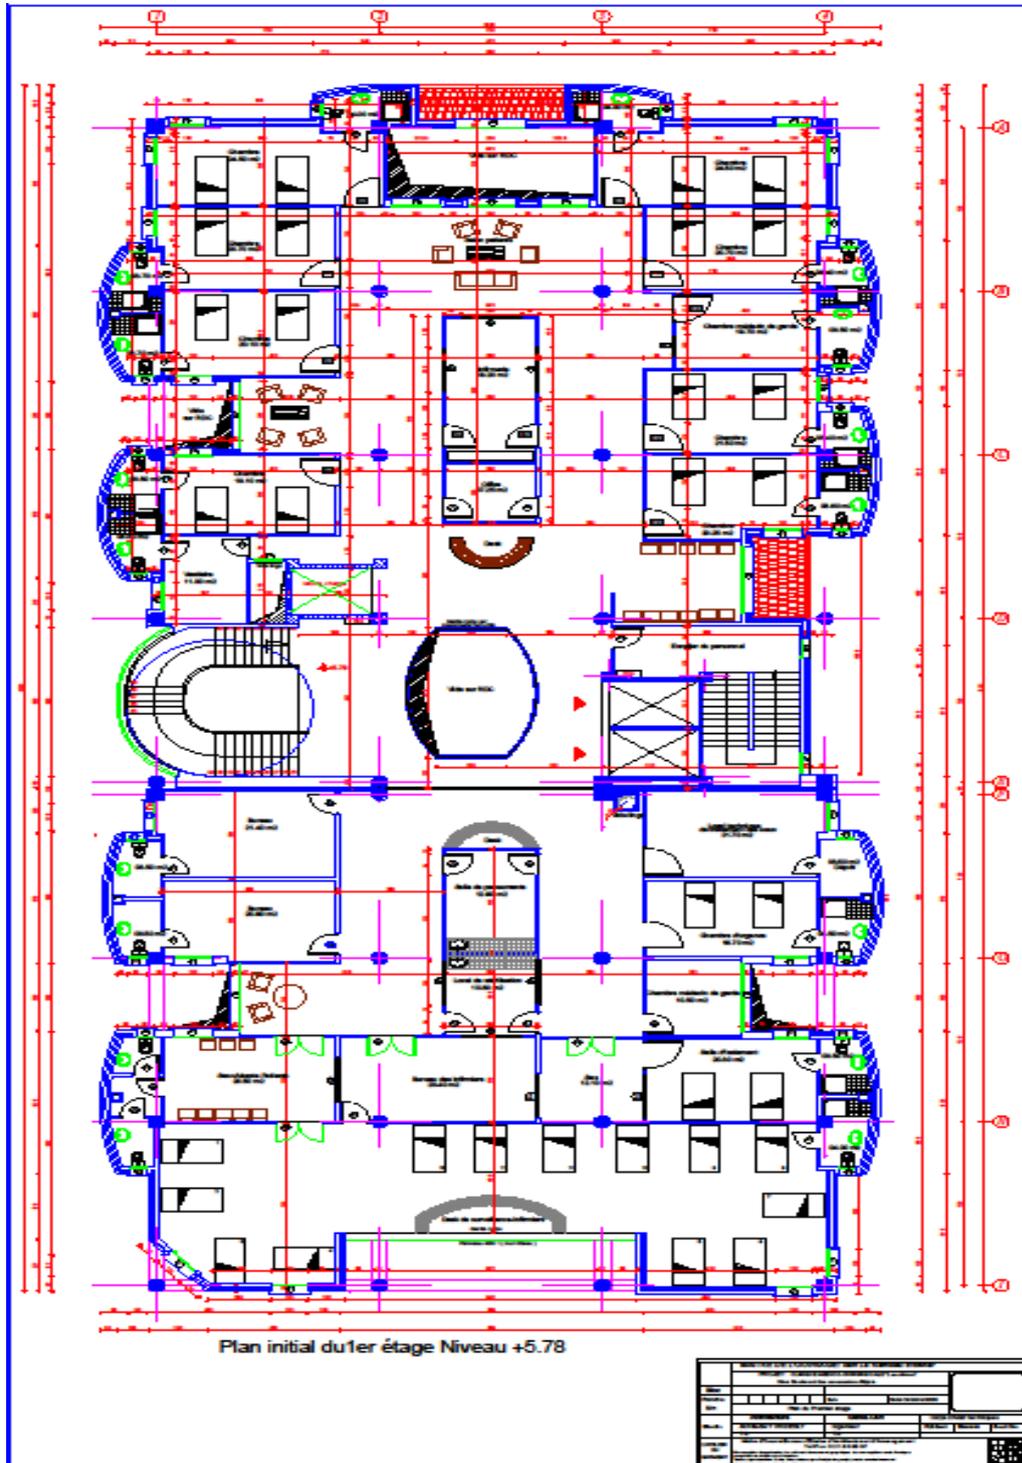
Plan Étage 1 de la clinique du RameauOlivier
